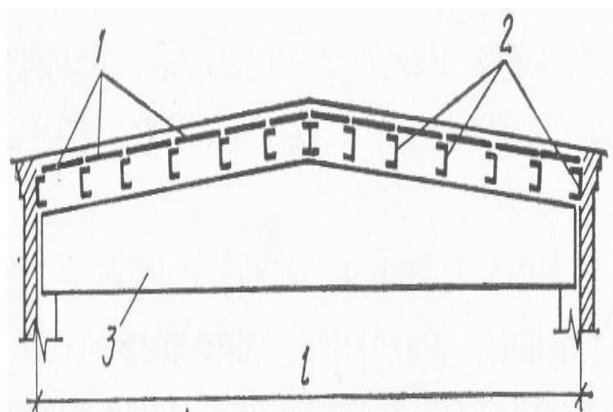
Конструкція перекриття по прогонах: 1-плити; 2- прогони; 3- несуча конструкція
